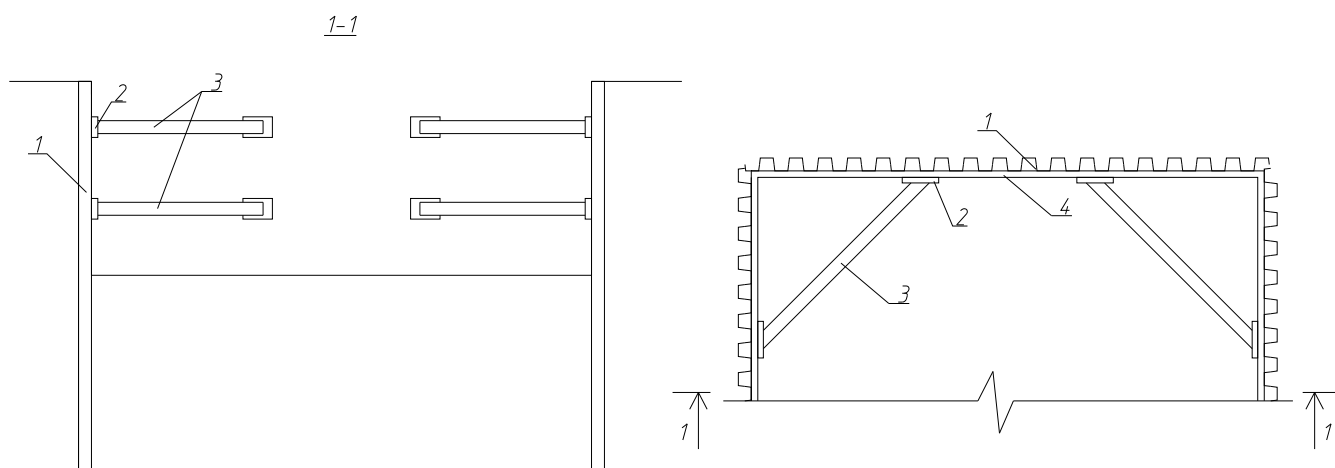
Усиление раскосами: 1 – шпунтовое ограждение; 2 – опорная площадка; 3 - раскос; 4 – обвязочная балка
